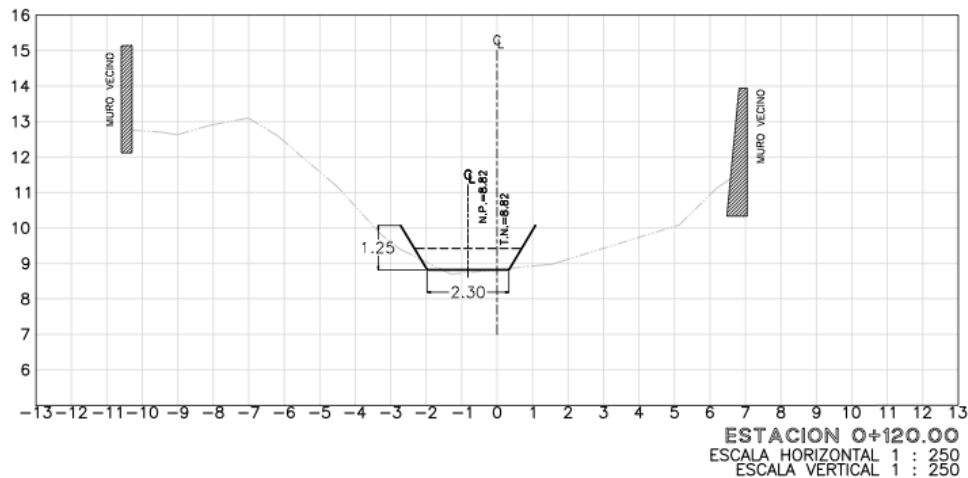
SECCIÓN TIPO DE LA OBRA DE ENCAUZAMIENTO
